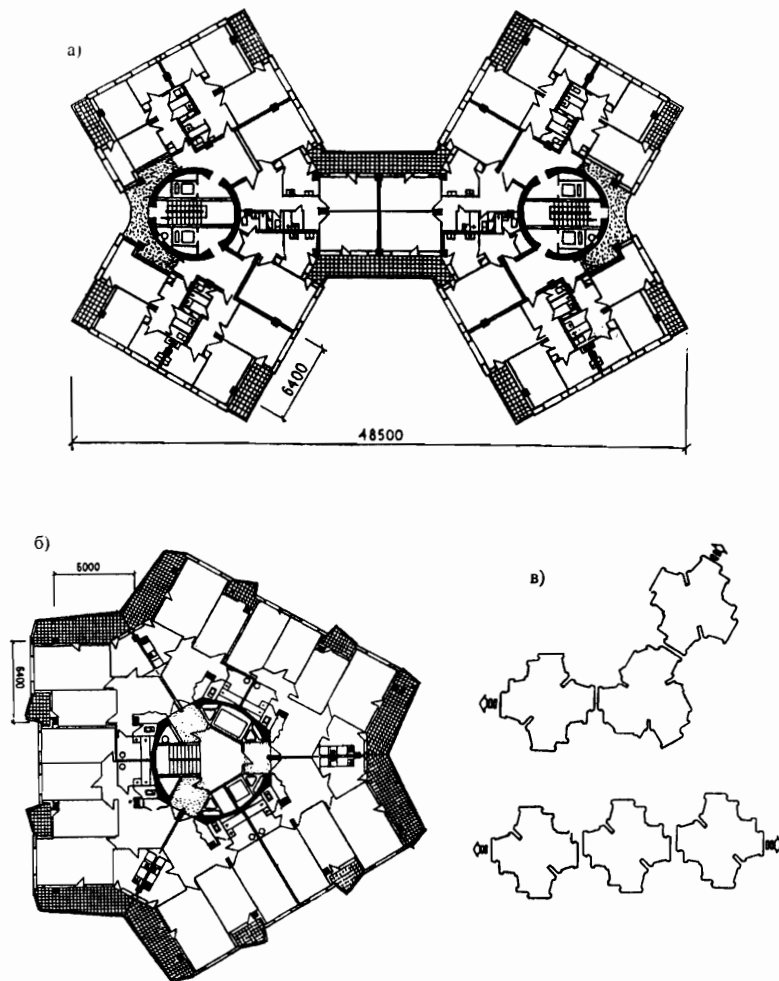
Планы типовых этажей жилых домов и жилых комплексов: а - 12-этажный 132-квартирный жилой дом (г. Душанбе); б - 16-этажный 90-квартирный жилой дом (г. Ереван); в - градостроительные образования криволинейной и линейной форм
